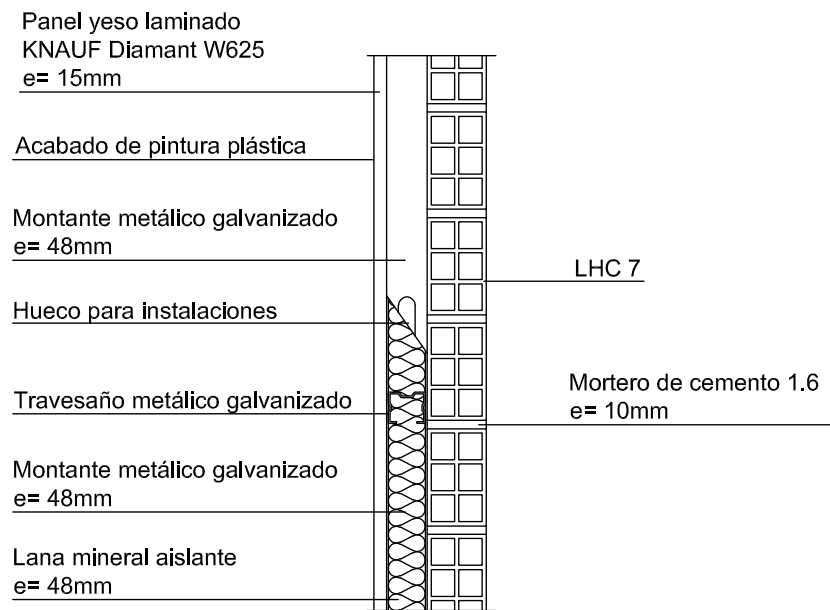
Sección constructiva de tabiquería y trasdosados tipo T4, 2016, fuente propia.
